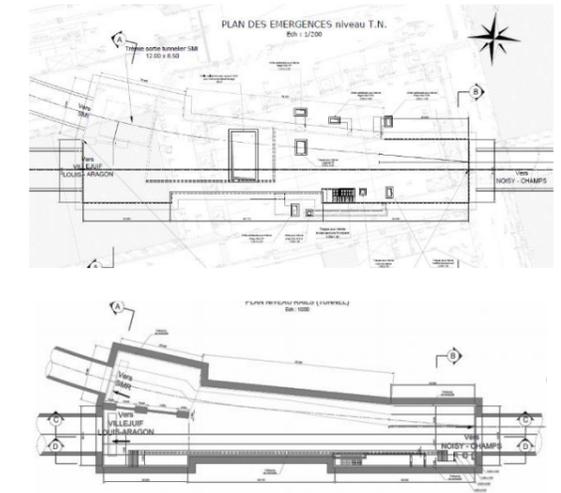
Coupe - Vue en plan niveau Tunnel - Vue en plan Niveau TN OS 1401P
